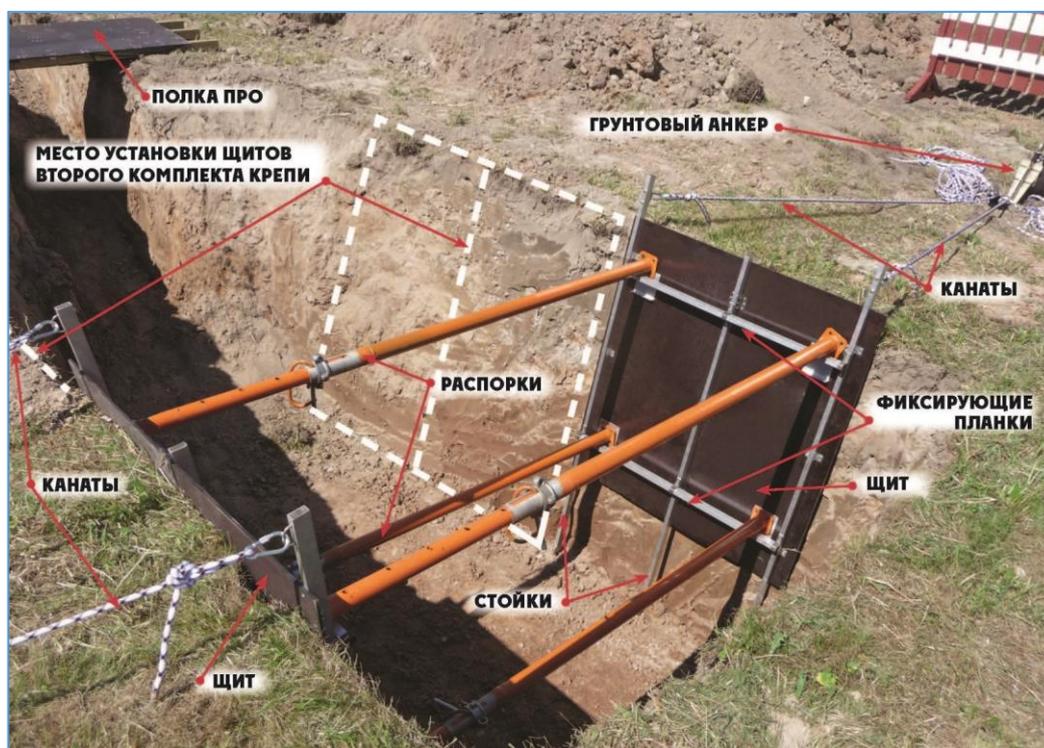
Варианты крепления откосов котлована или траншеи
